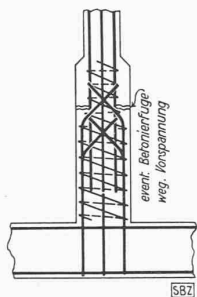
Hängestab in Eisenbeton, Armierungsstoss
